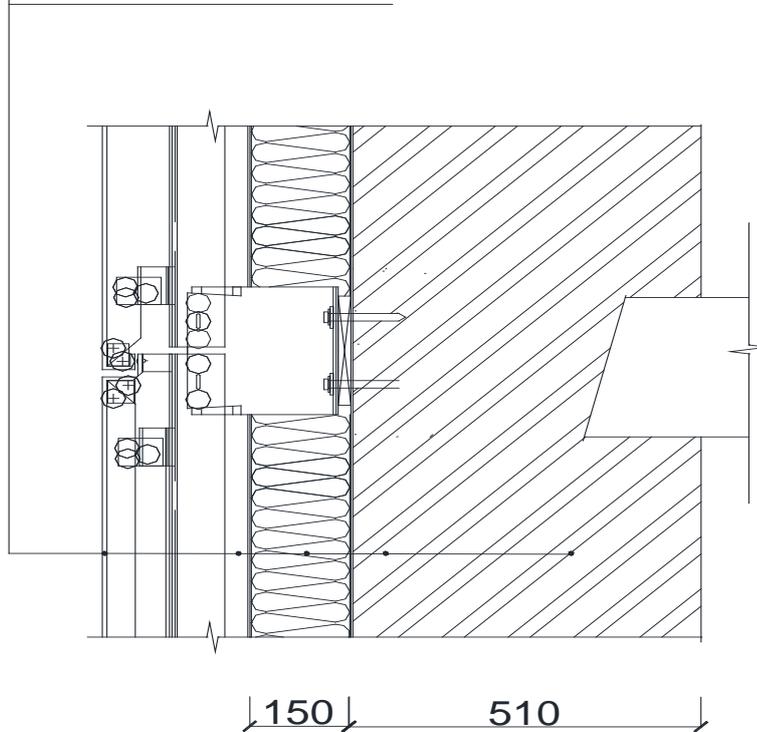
Розрахункова схема огорджувальної конструкції
